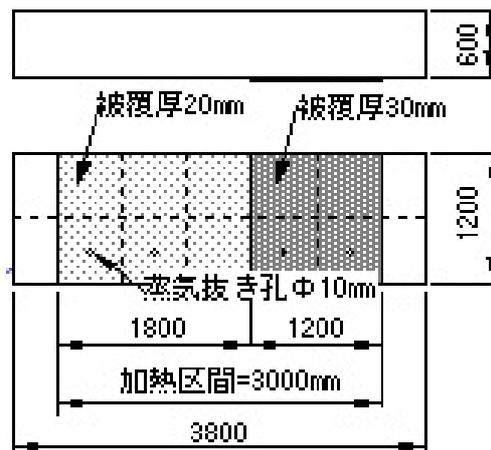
コンクリート充填鋼殻試験体の耐火被覆設置状況
